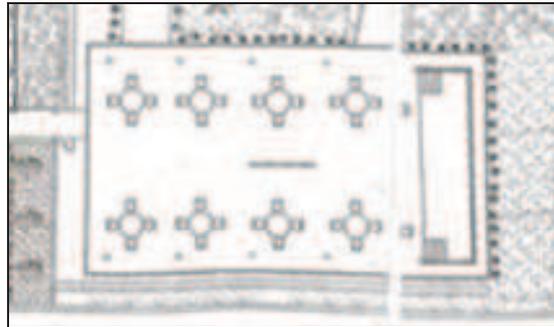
Pátio do abrigo segundo a planta baixa da instituição.
